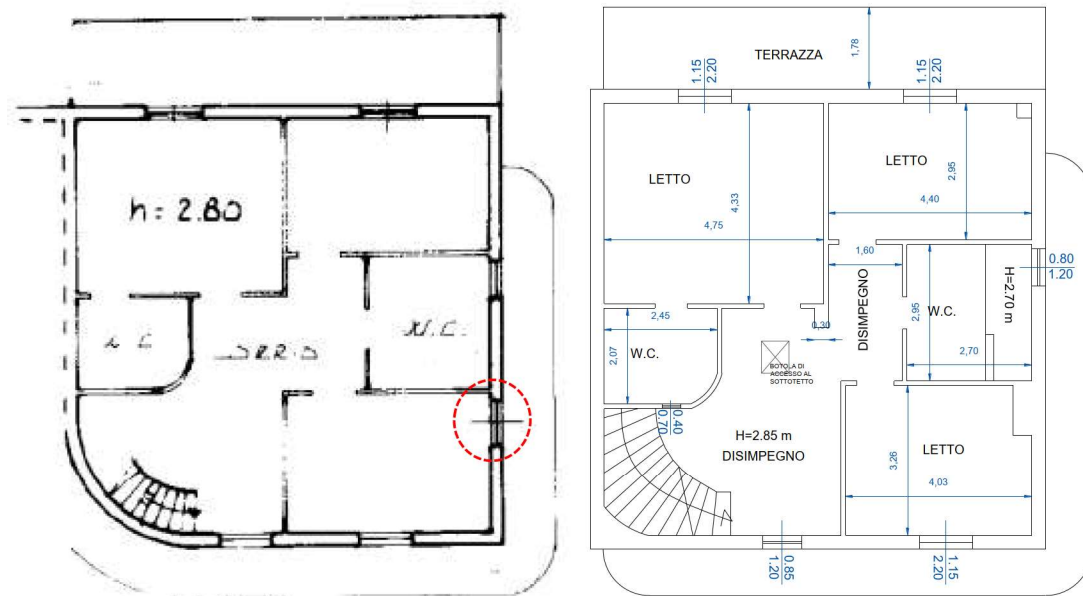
Raffronto planimetria catastale (a sinistra) e planimetria stato di fatto (a destra) - Piano primo
